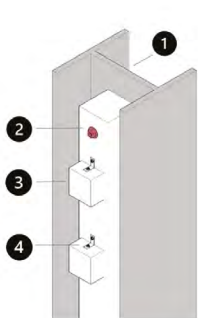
Ensamblaje de los módulos, refuerzo de vanos y unión del sistema B-Pallets a marcos rígidos
